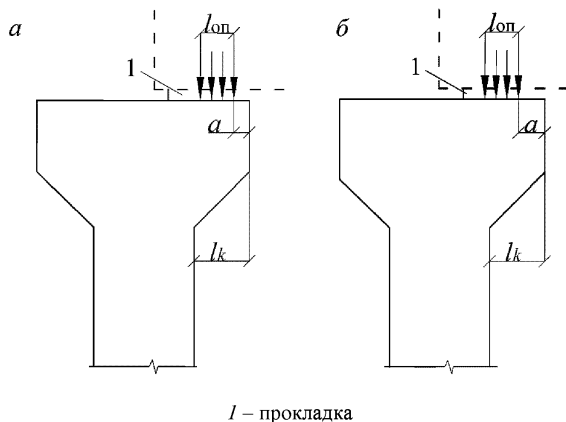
Схема приложения нагрузки от покрытия на консоль
